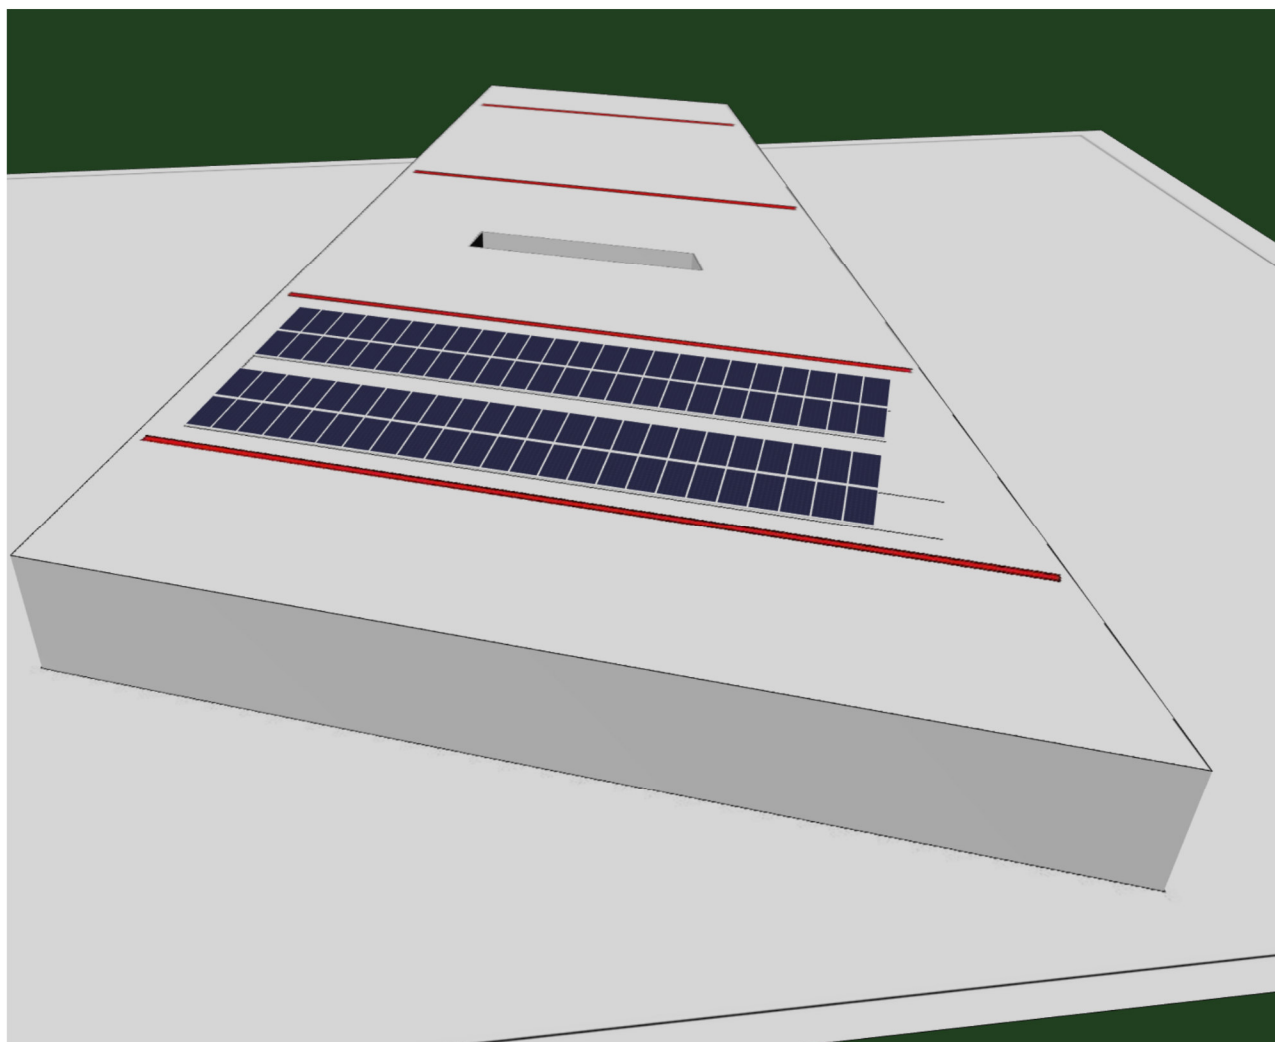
Stralcio planimetrico dell'impianto fotovoltaico
